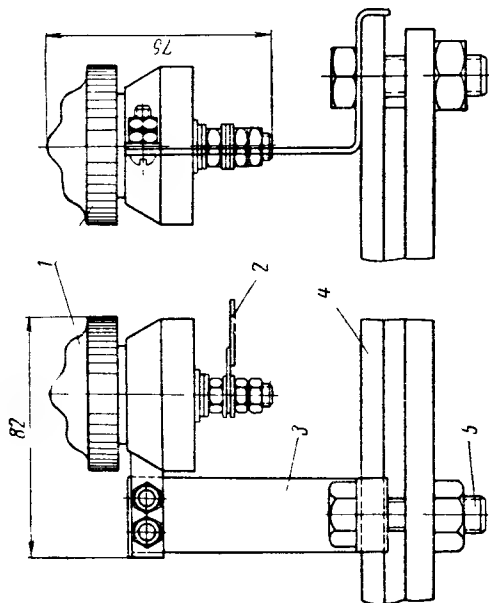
Установка пробивного предохранителя для внутренней установки. При наружной установке предохранитель закрывается стальным колпаком:
